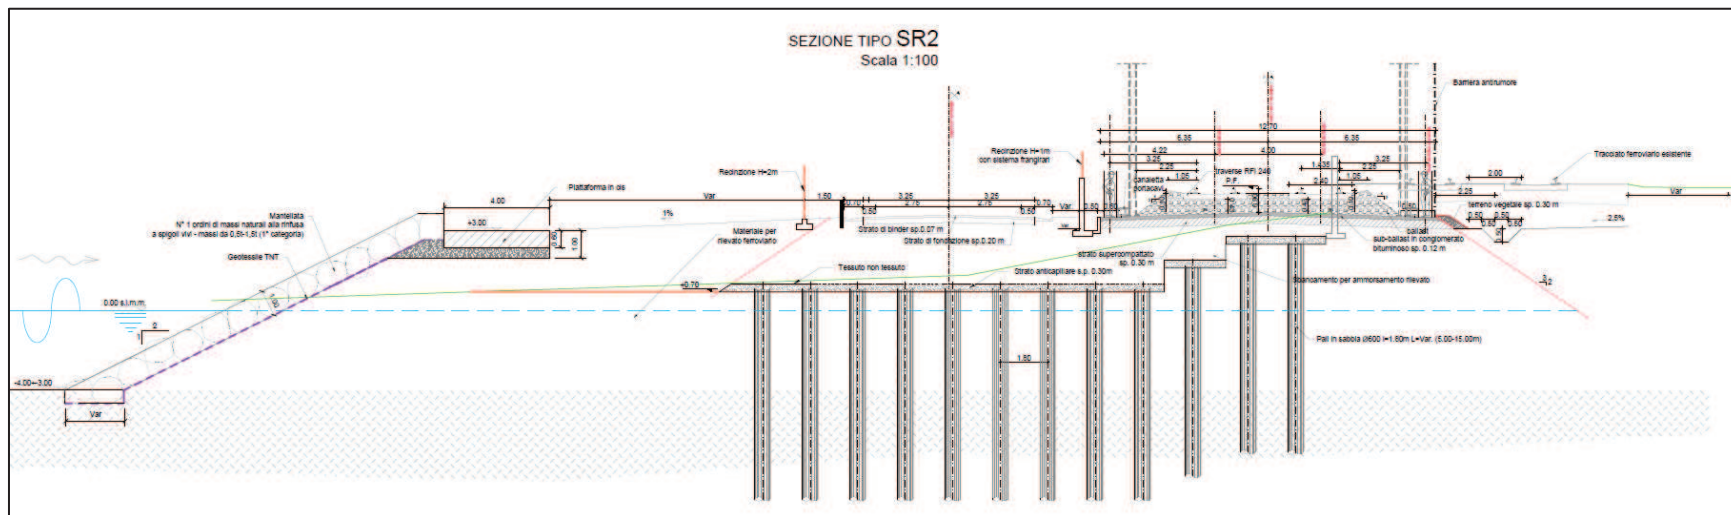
Sezione tipo rilevato ferroviario e stradale
